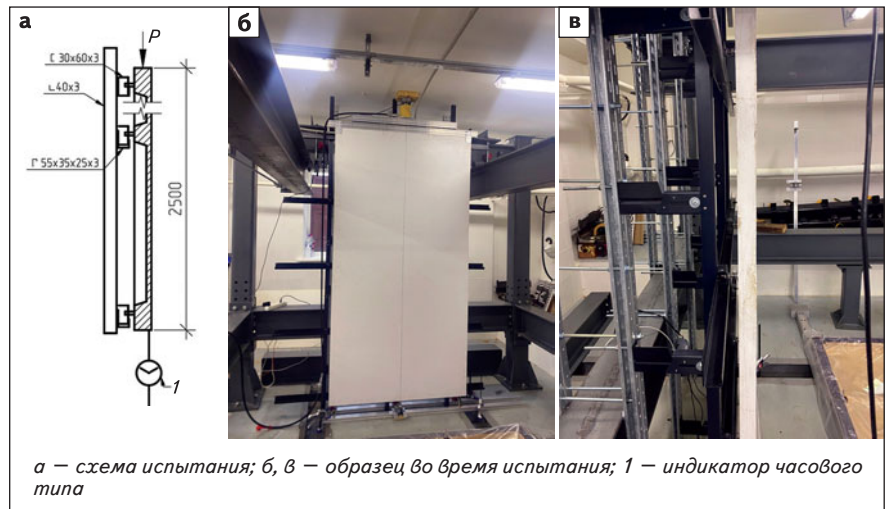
Испытание полимербетонной панели на вертикальную разрушающую нагрузку
